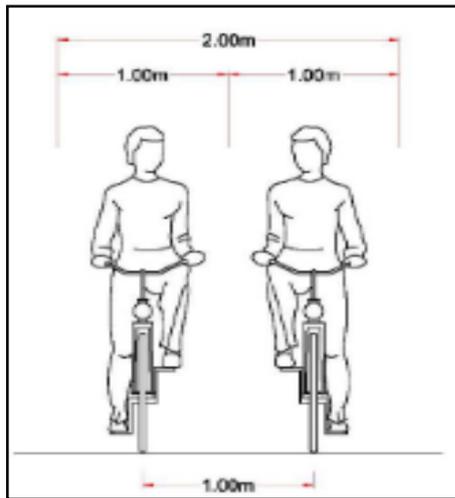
Ancho de ciclovía unidireccional para adelantamiento.
